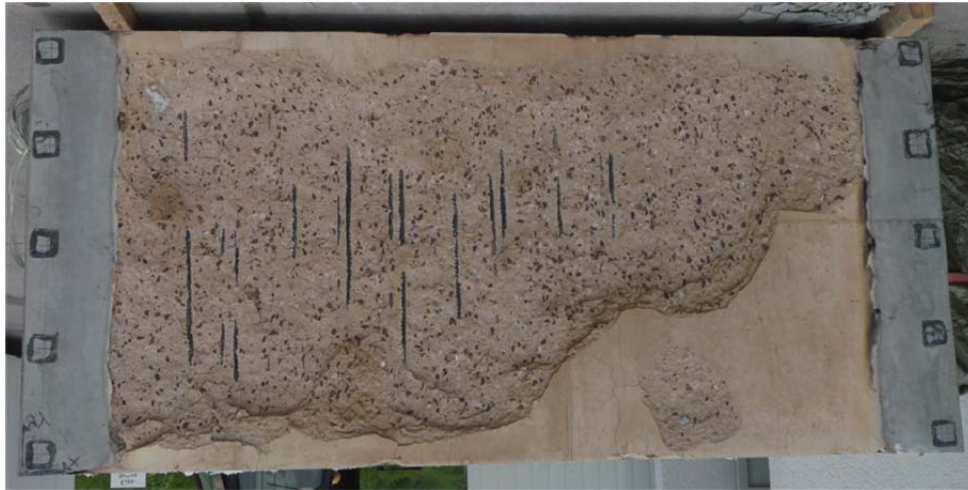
Betonprobekörper nach einem Brandexperiment.
